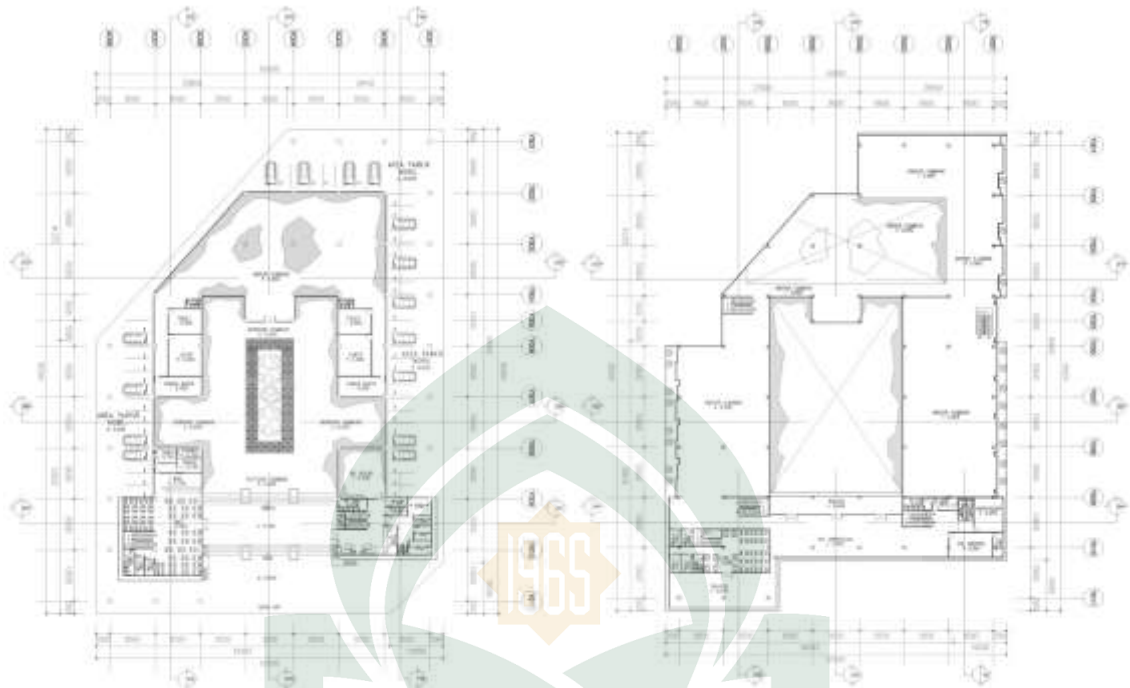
Struktur Wahana Olahraga Panjat Tebing
